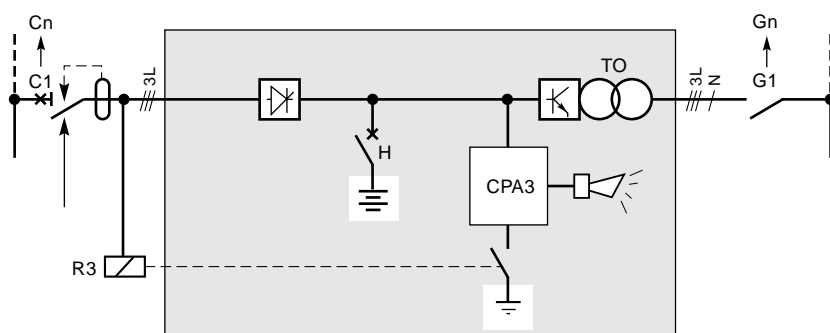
Vigilancia del aislamiento de una cadena de SAI's con batería de acumuladores no aislada de la instalación aguas arriba según esquema TT, y aislada de la instalación aguas abajo.
